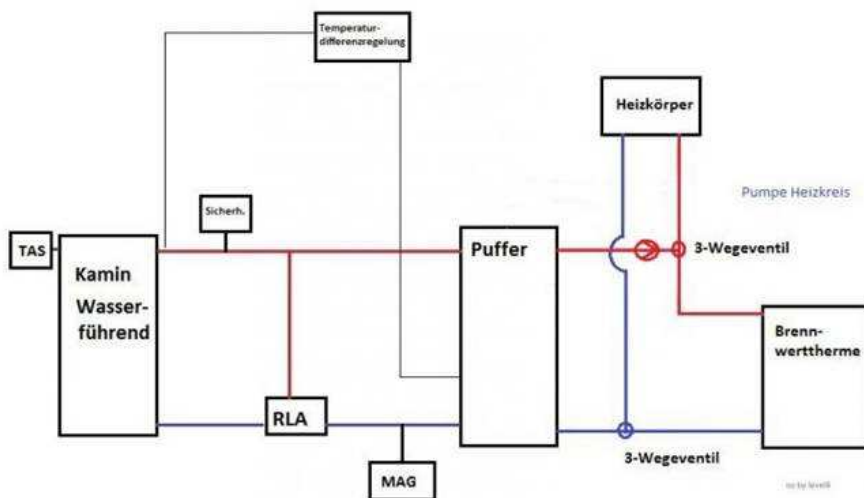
Hydraulikschema bei Einbindung in die bestehende Zentralheizung
